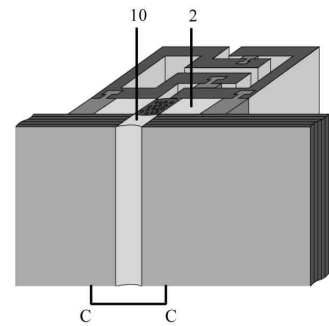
Systeem voor een 4-zijdige structurele beglazing.
